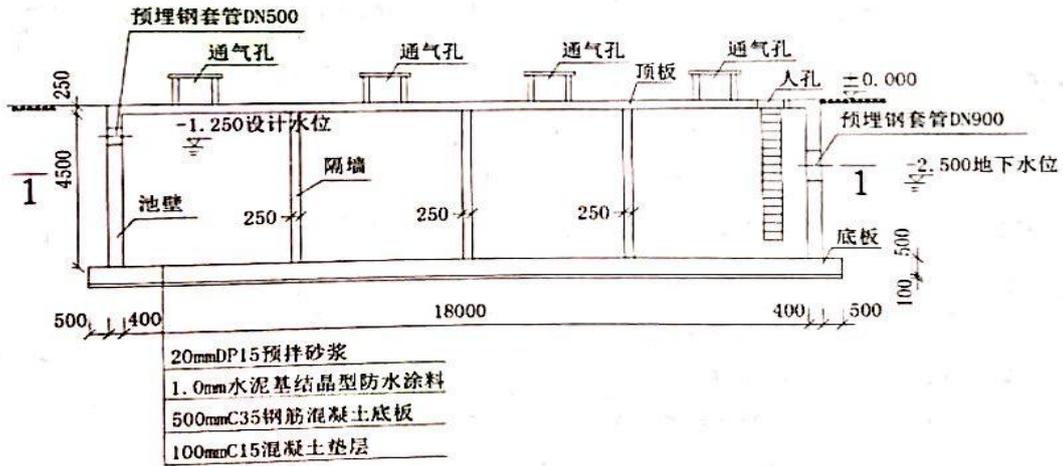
水池剖面图 (标高单位: m; 尺寸单位: mm)
